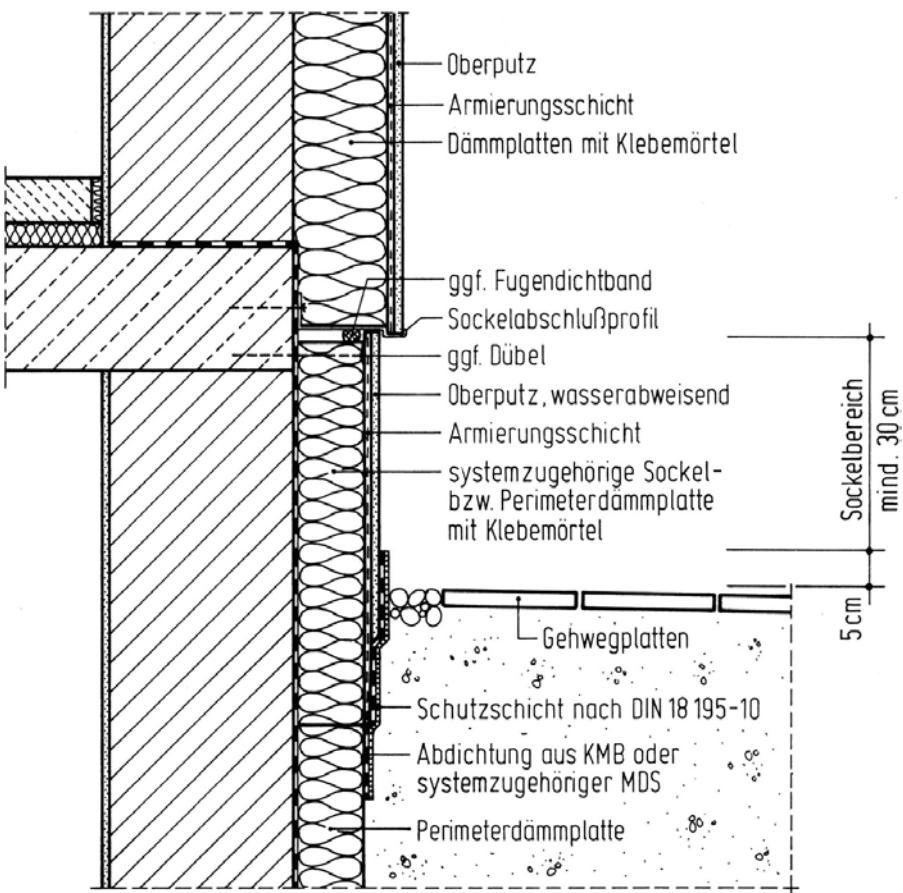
Schadensträchtige Sockelausbildung mit unterhalb der Geländeoberfläche endender Abdichtung und wasserundurchlässiger Verfüllung der Baugrube unterhalb des Kiesstreifens (Stauwasserbildung)
